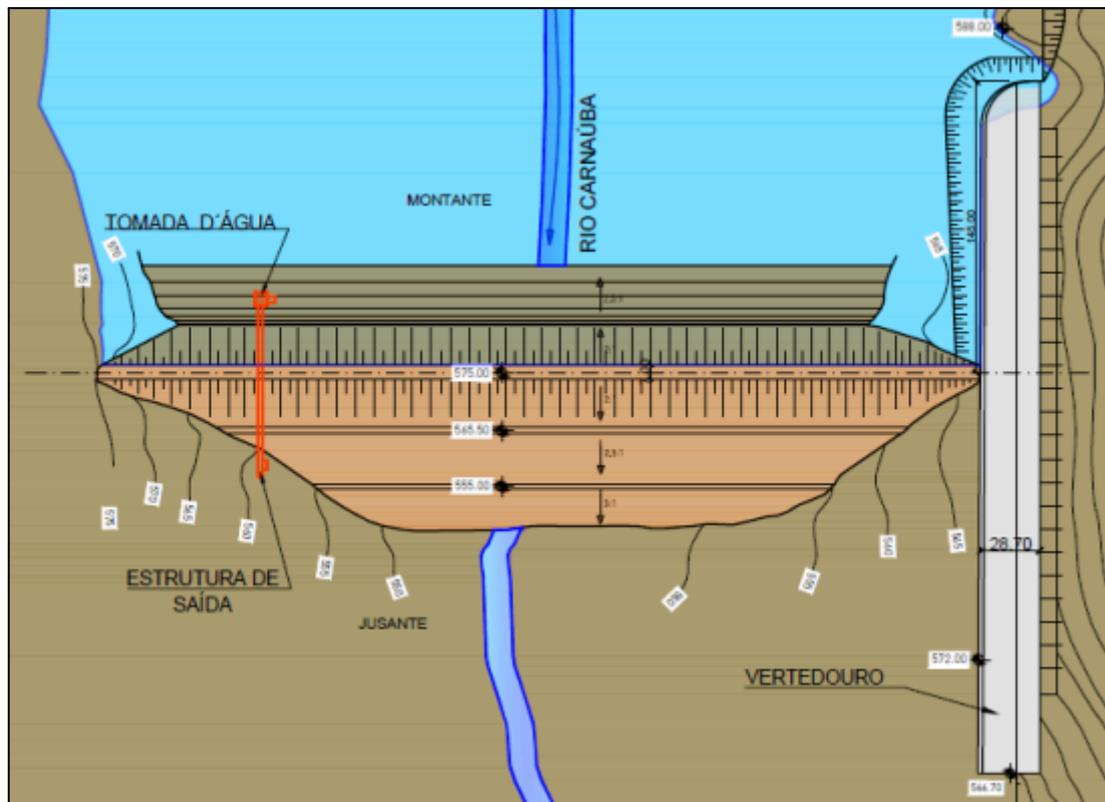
Planta Esquemática da Barragem e Estruturas Associadas.
